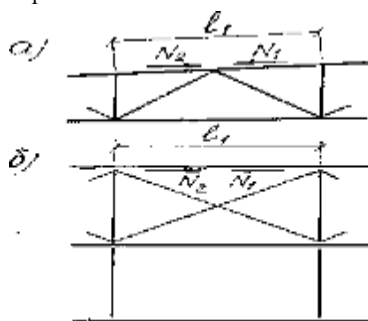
Схема для визначення розрахункових довжин поясу ферми: а – схема ферми; б – схема поперечних горизонтальних в'язей між фермами (вид зверху)
